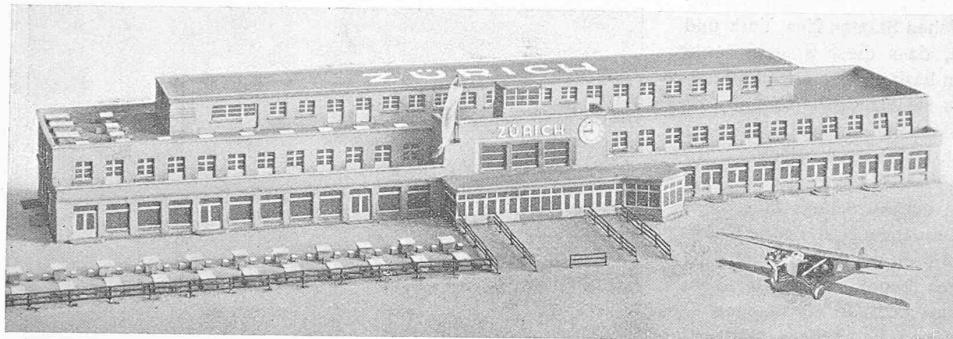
Modellbild des projektierten Stationsgebäudes (4 in untenstehendem Plan).
